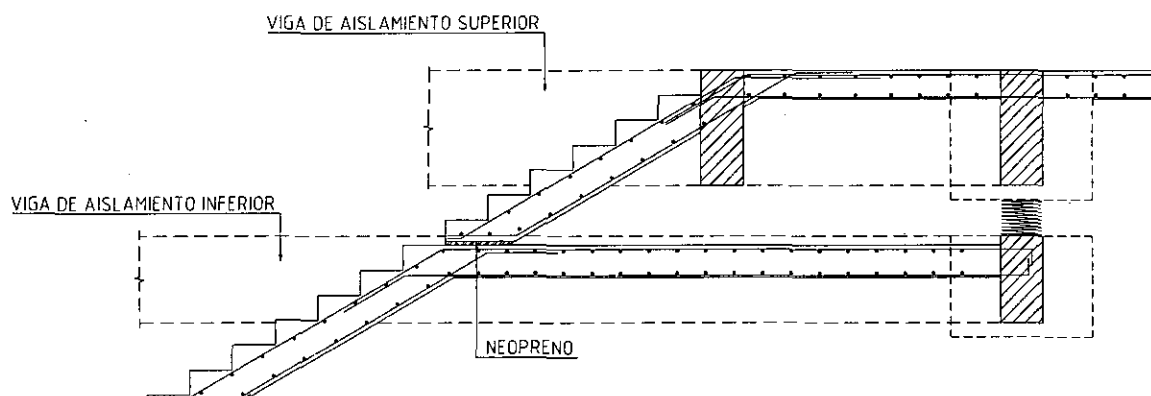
Detalle de escalera que pasa por el nivel de aislamiento.
